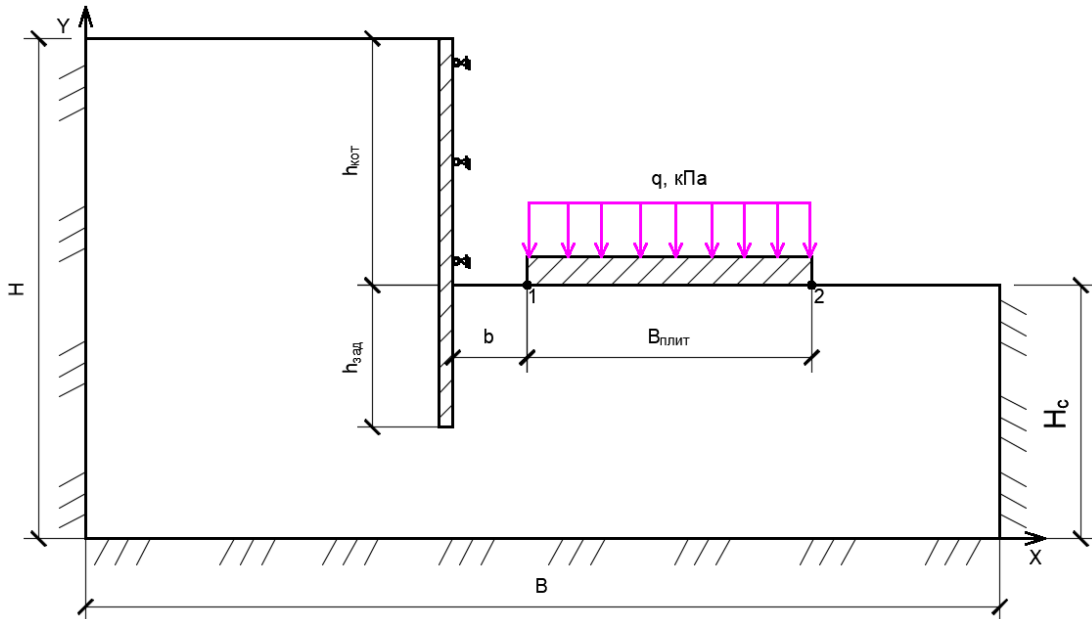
Расчетная схема для случая здания, смещенного к ограждению котлована
